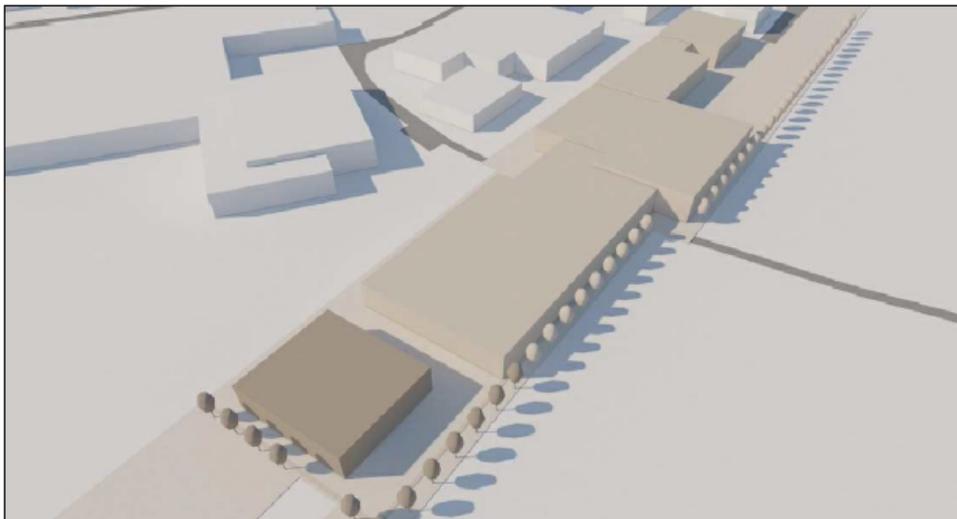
Render volumetrico – Vista aerea planimetrica dell'intervento con ripresa da lato Sud-Est
